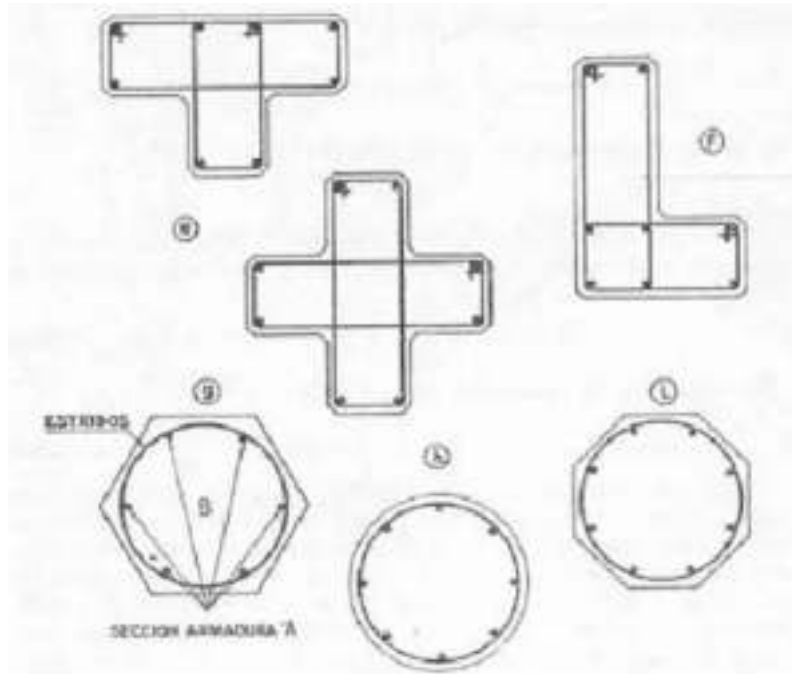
Diferentes tipos de columnas de Hormigón Armado
